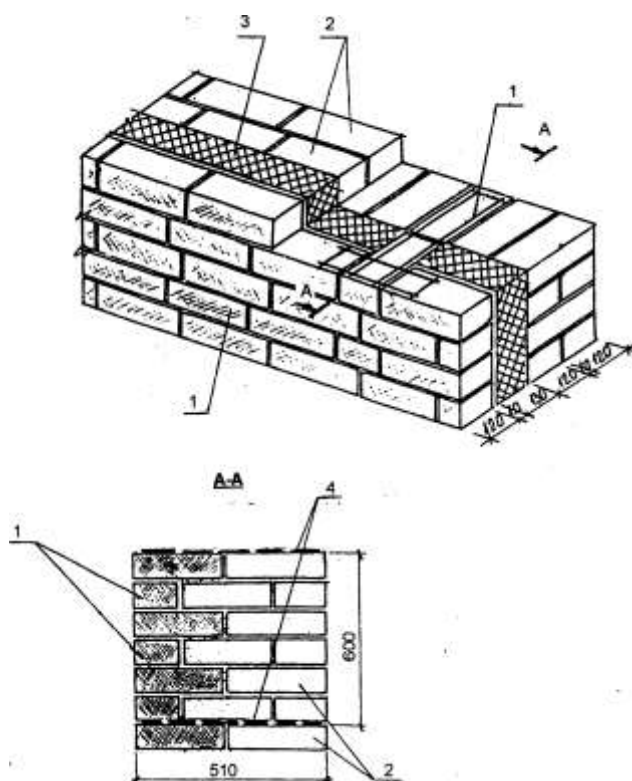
Кирпичная кладка наружных стен с жесткими связями и утеплением пенополистирольными плитами:
